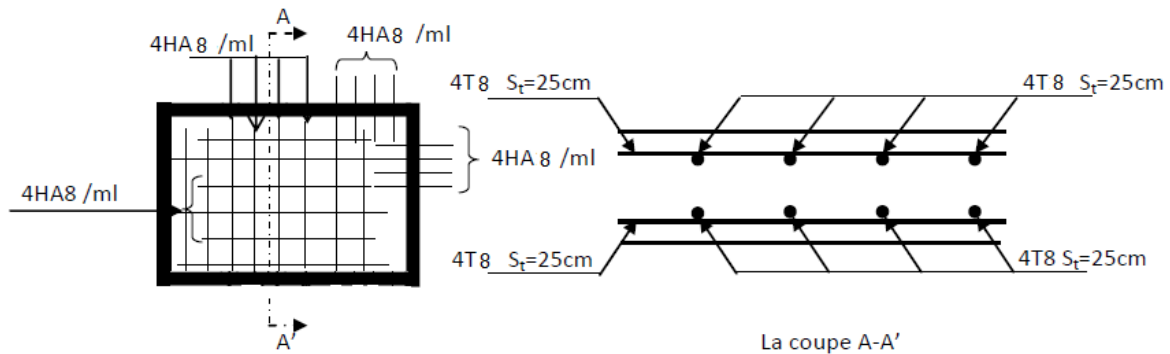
Schéma du ferrailage de la dalle pleine (cage d'escalier).
